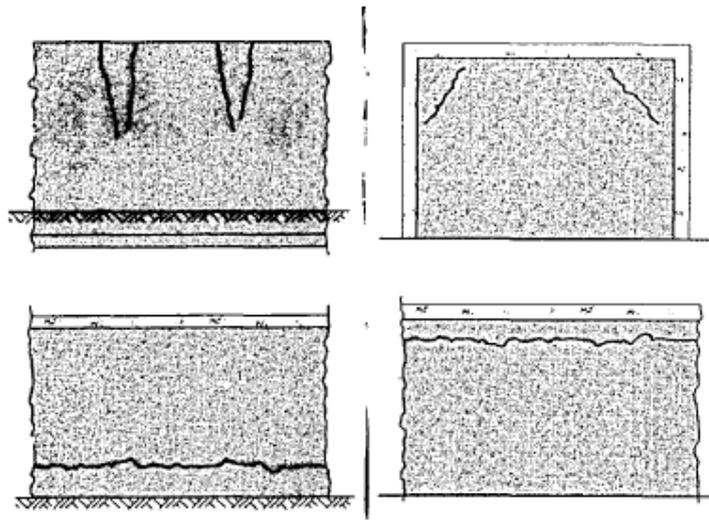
FISURAS DE CONTRACCIÓN HIDRÁULICA Y TÉRMICA
